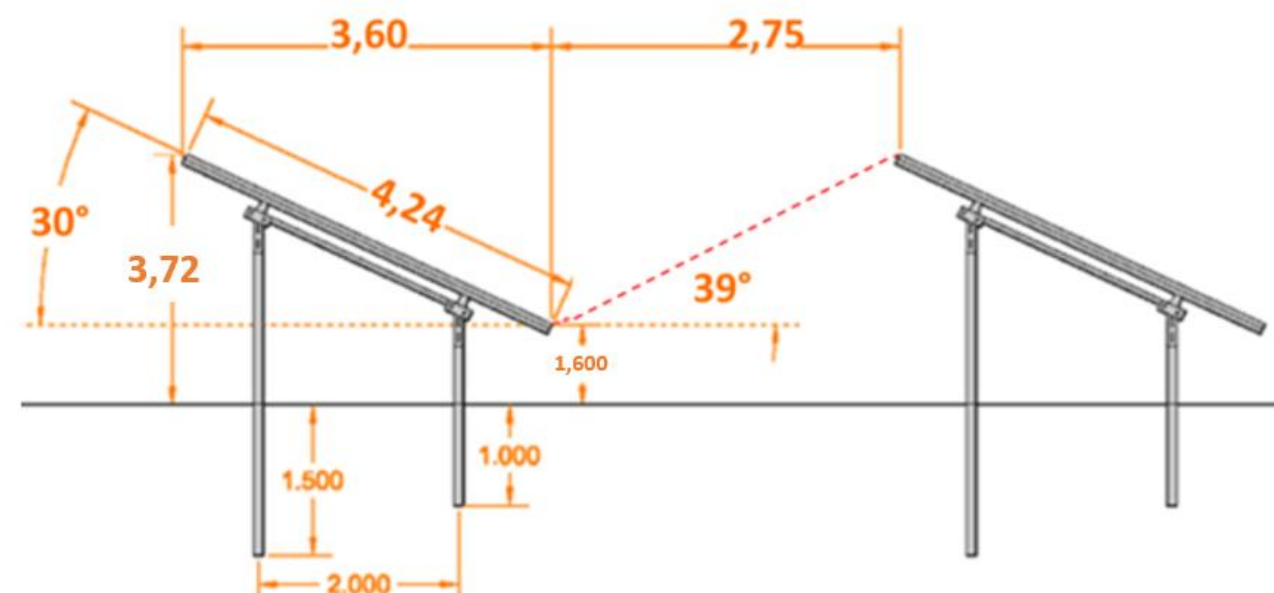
Plan des structures solaires pour la partie élevage de volailles.
